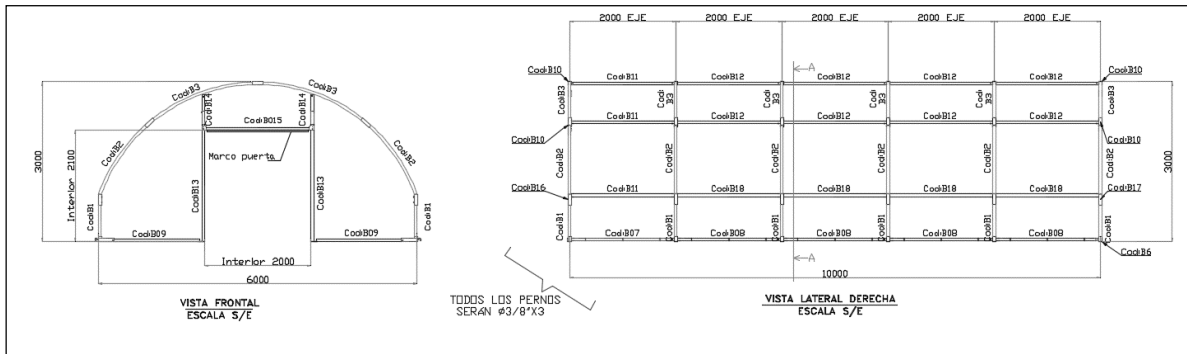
Plano en Planta Cobertizo diseño 04. Paratía, Puno
